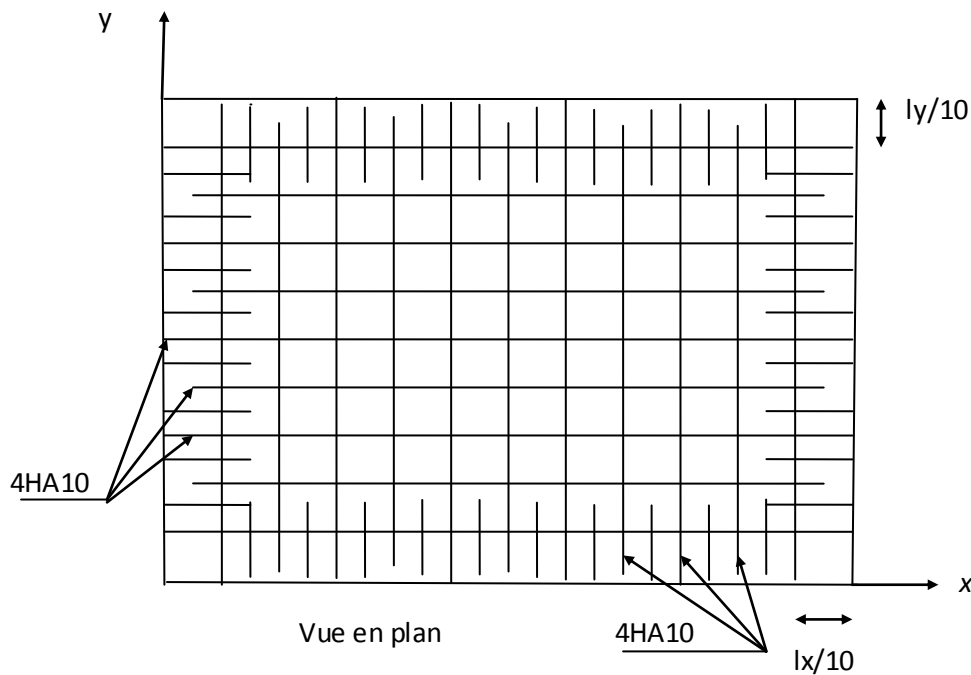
Schéma de ferrailage de la dalle d'ascenseur
